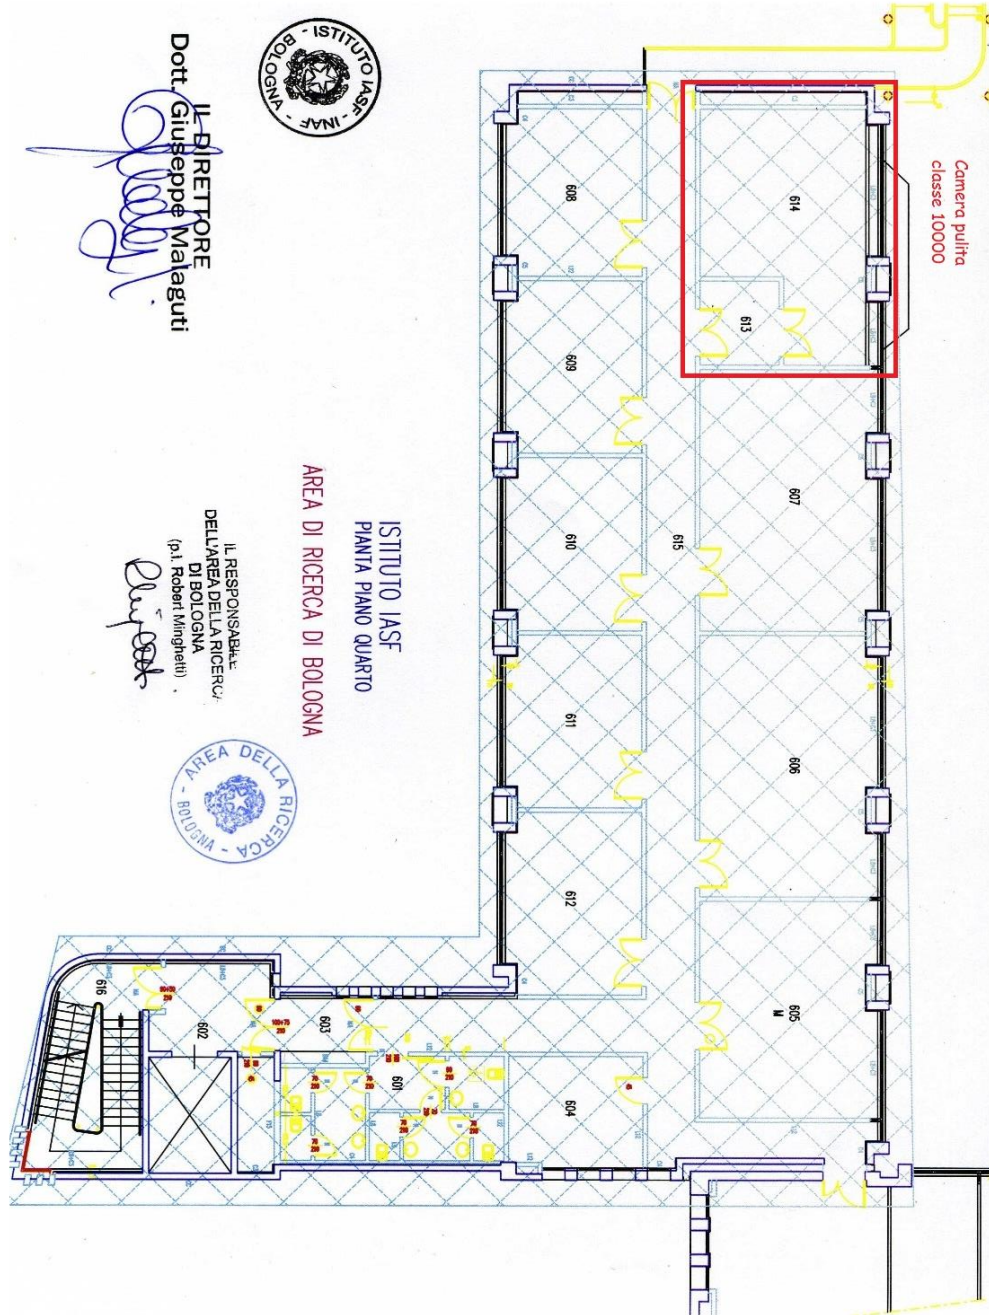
a Planimetria locale Camera pulita IASF BO.
